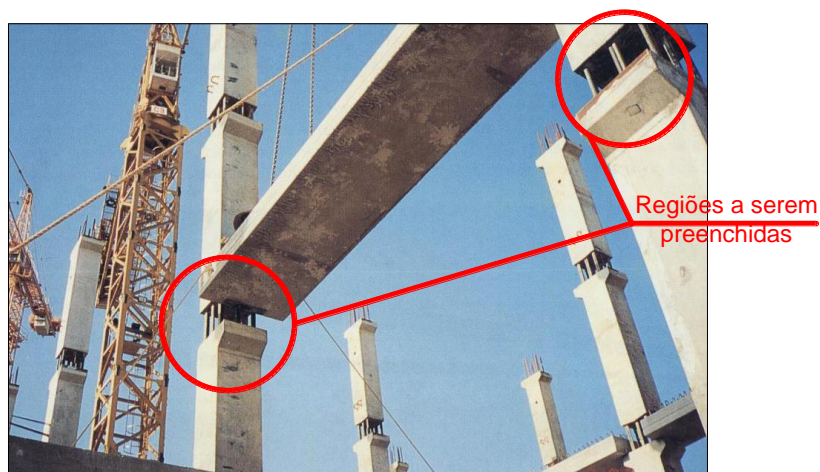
7 – Ligação rígida entre viga e pilar (FONTE: Ferreira, 2008).
